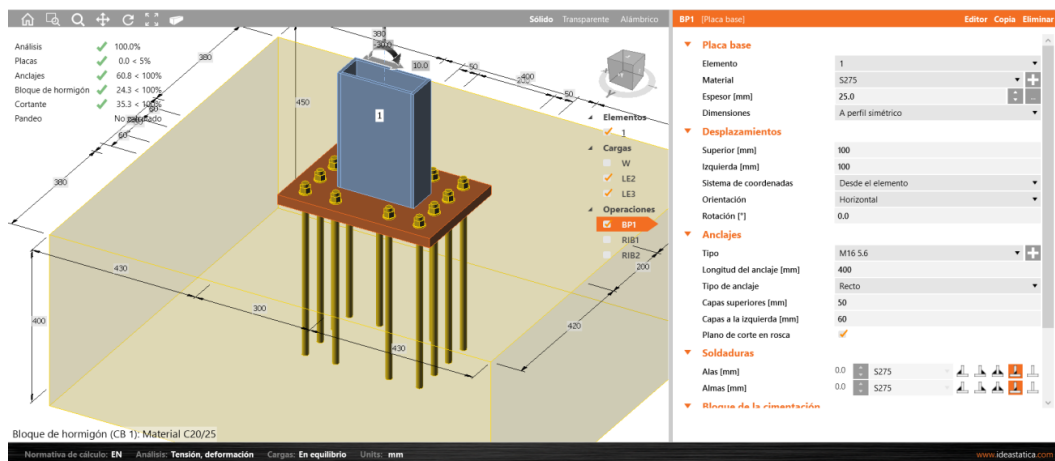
Cálculo con IDEA StatiCa de la placa de anclaje ara el soporte pésimo.
